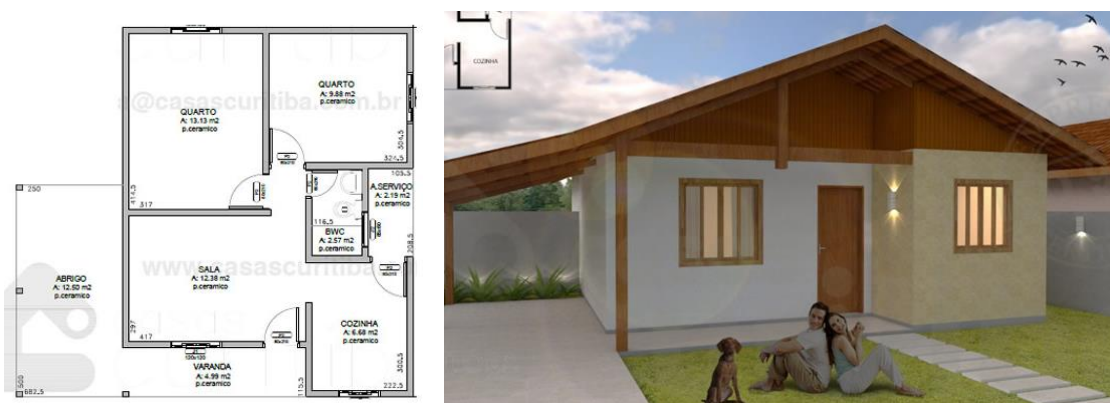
Planta e vista do módulo promocional T2 com 72 m² [37]
